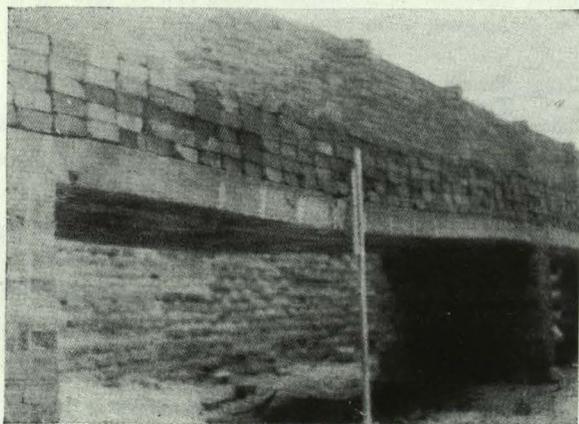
Losa de ensayo con sobrecarga de 540 kg/m²
